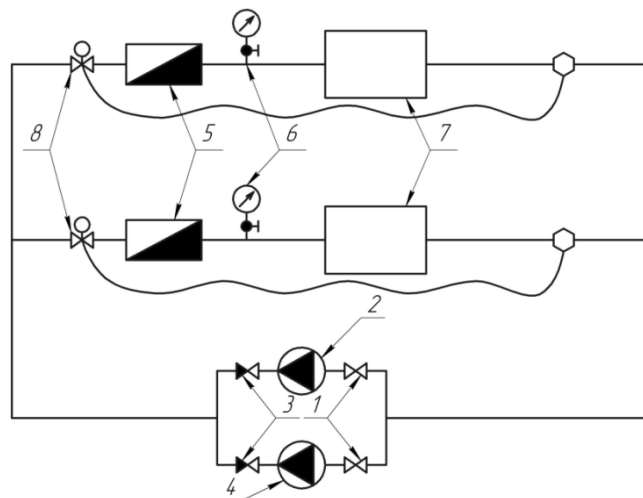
Схема установки з регулятором перепаду тиску
